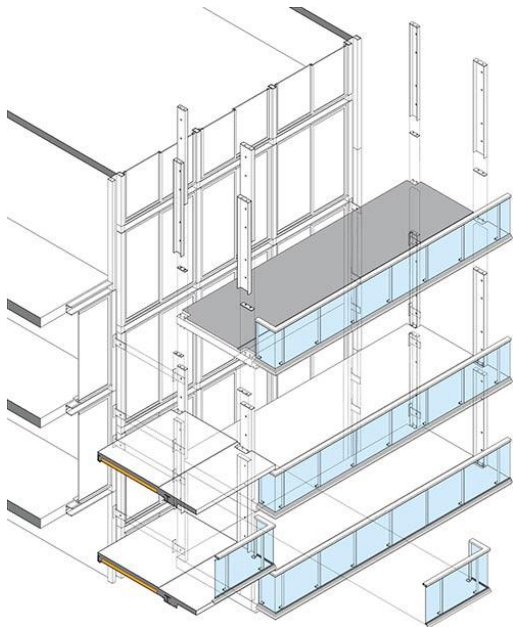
Sistema estructural prefabricado. Fuente: tectónica.es
